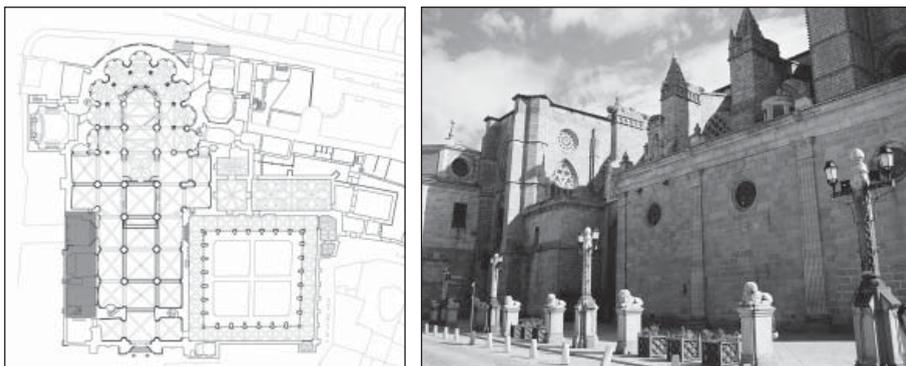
Localización en planta de la actuación en el «Paredón» y vista actual de lo construido (ACA).
